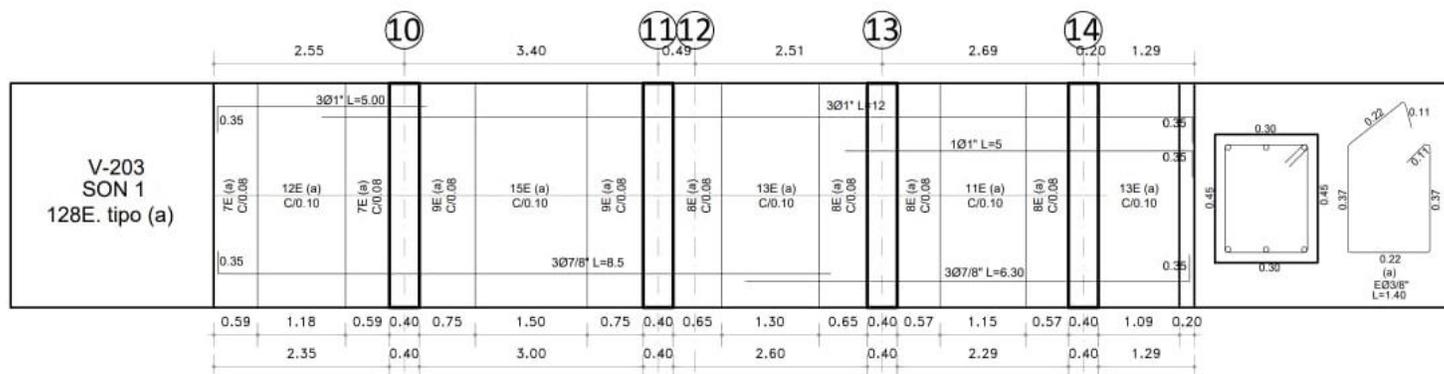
Viga 0.30x0.45 y Sección Estructural 203.
